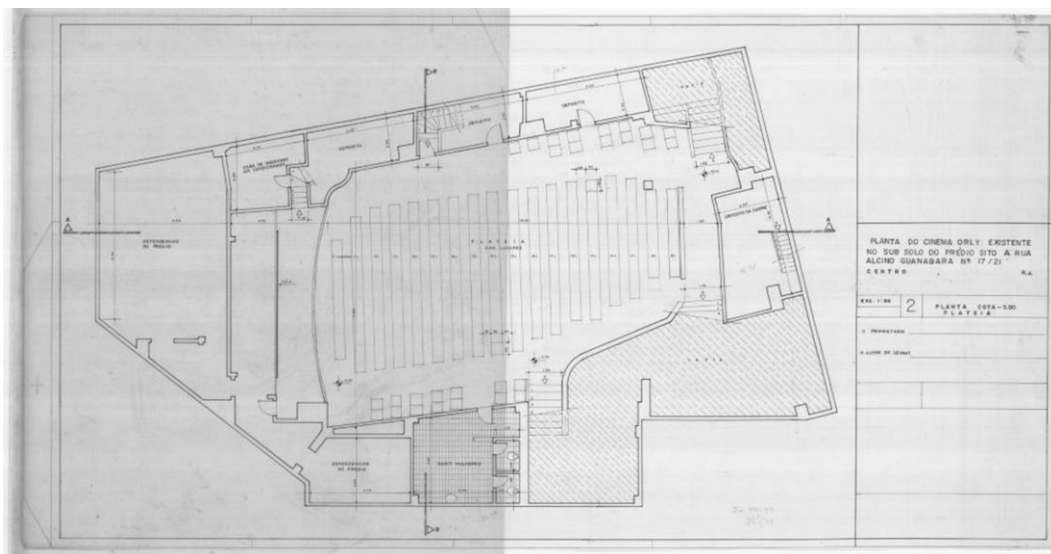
Planta Baixa da área da plateia do Cine Orly. Fonte: cedido pela família Valansi, atual proprietária do estabelecimento.
